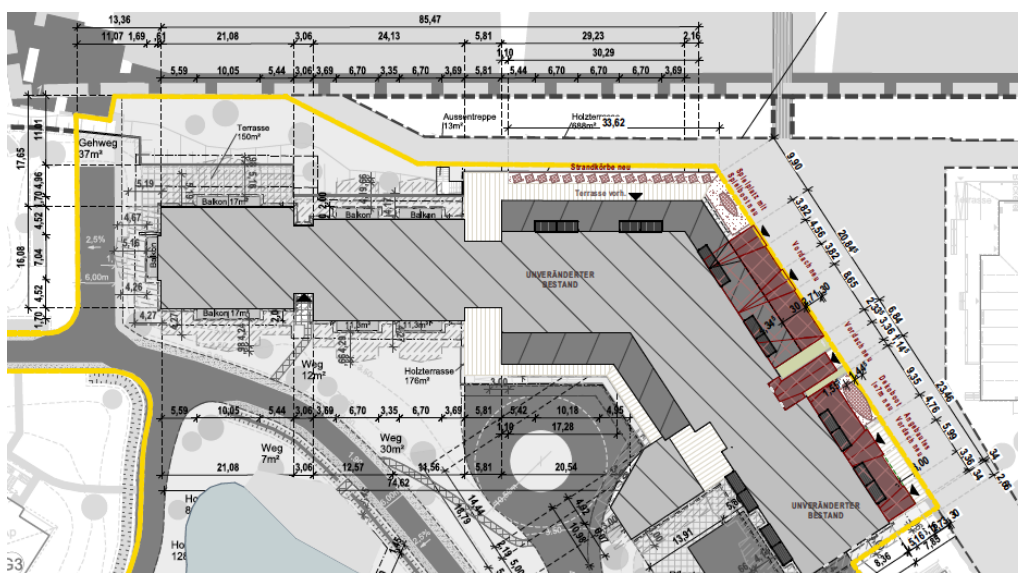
Auszug Lageplan 1.1 (Quelle: Architekturbüro Ladehoff, Stand 05-2023); Änderungen in Dunkelrot, Bestand in Grau
